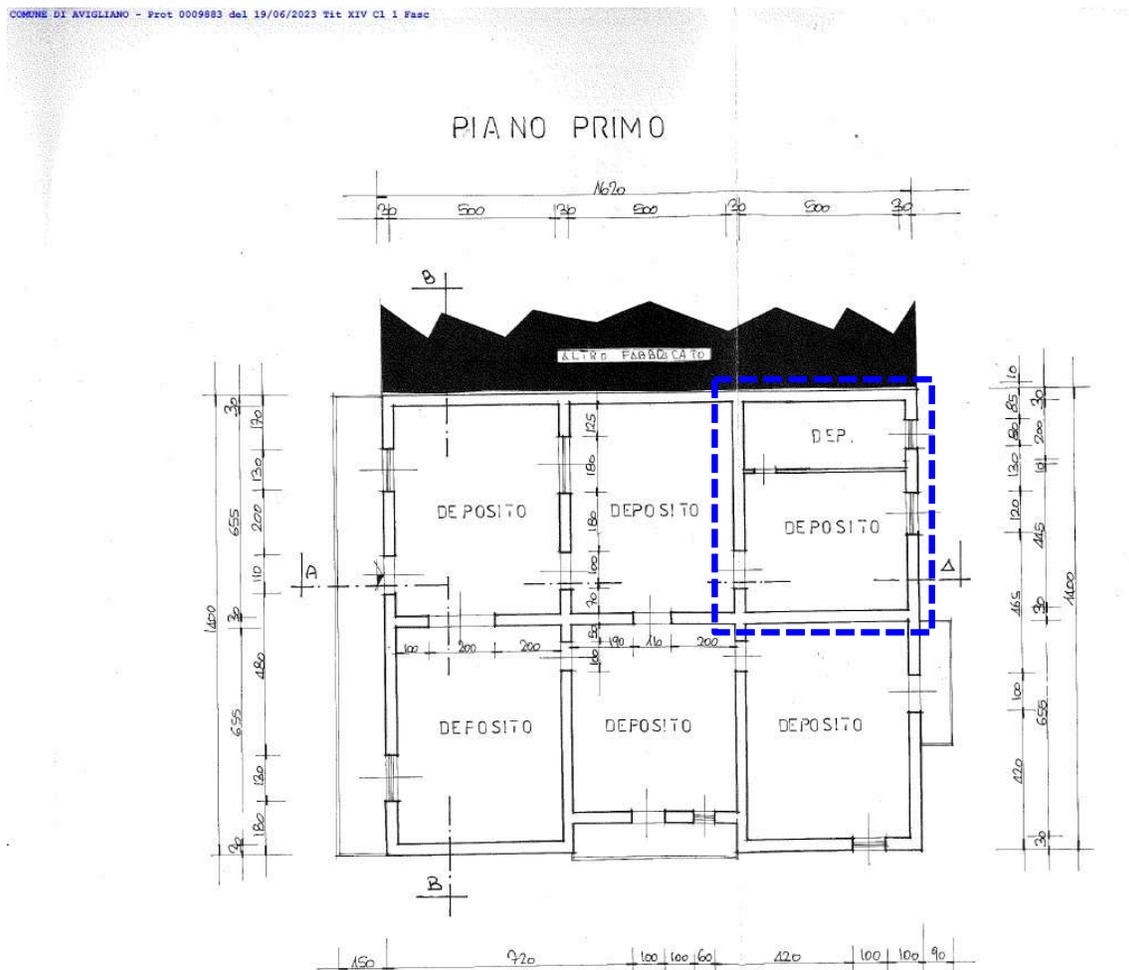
Pianta Piano 1° allegata alla *“Concessione Edilizia- Contributo (Fondi Cipe 1987/1988) per la Ricostruzione di Immobile danneggiato dal sisma”, n. 788 del 6.12.1986 – Provvedimento n. 284”
